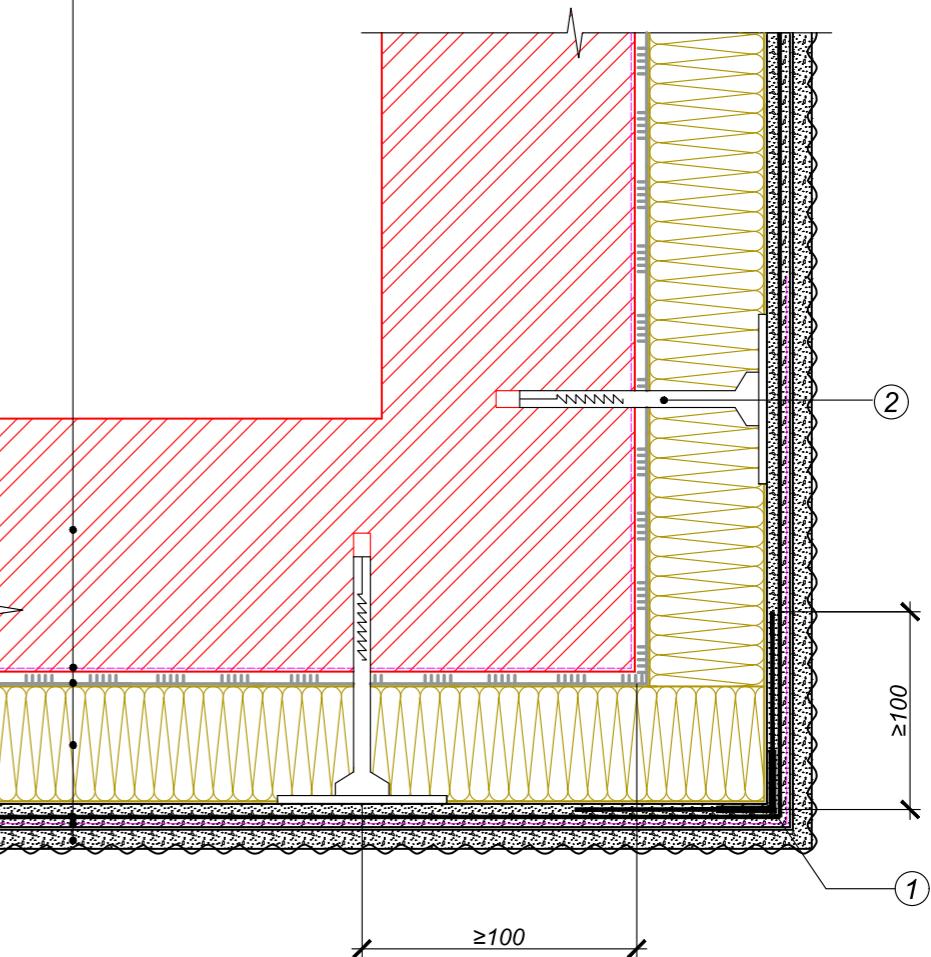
Устройство системы на внешнем вертикальном углу здания
